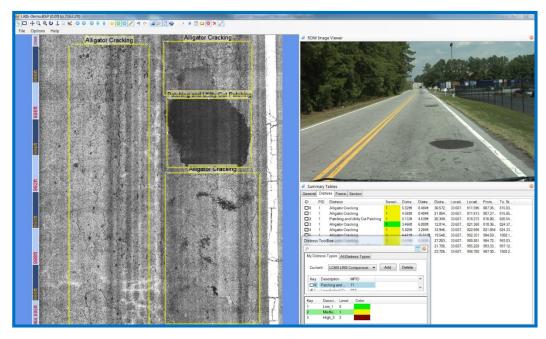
Información de salida de equipos de relevamiento de la condición superficial del pavimento.
